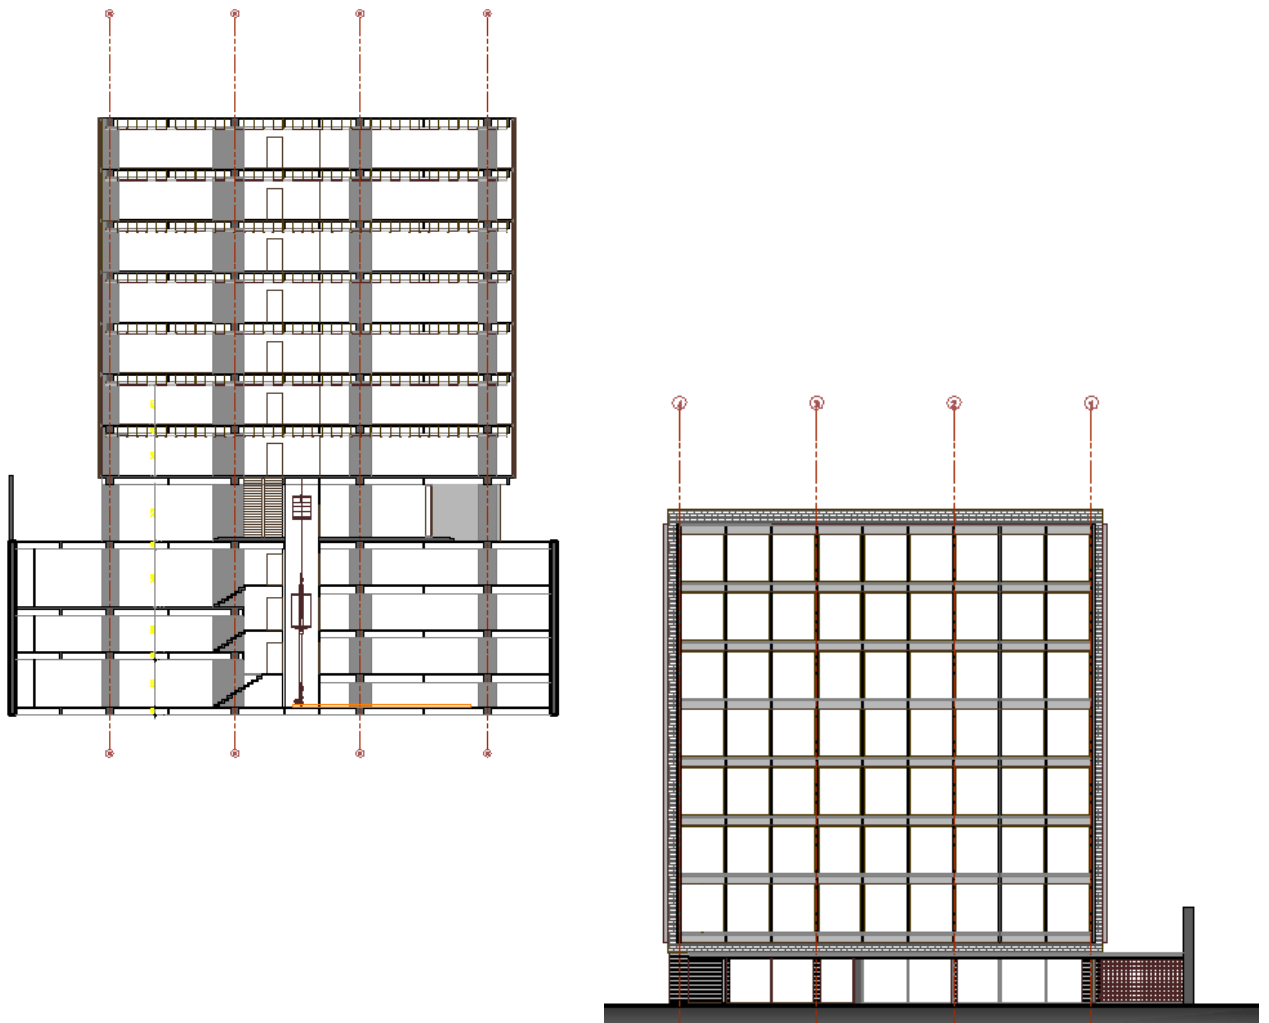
Fachadas del proyecto ONE 93. Fuente del contratante del proyecto.
